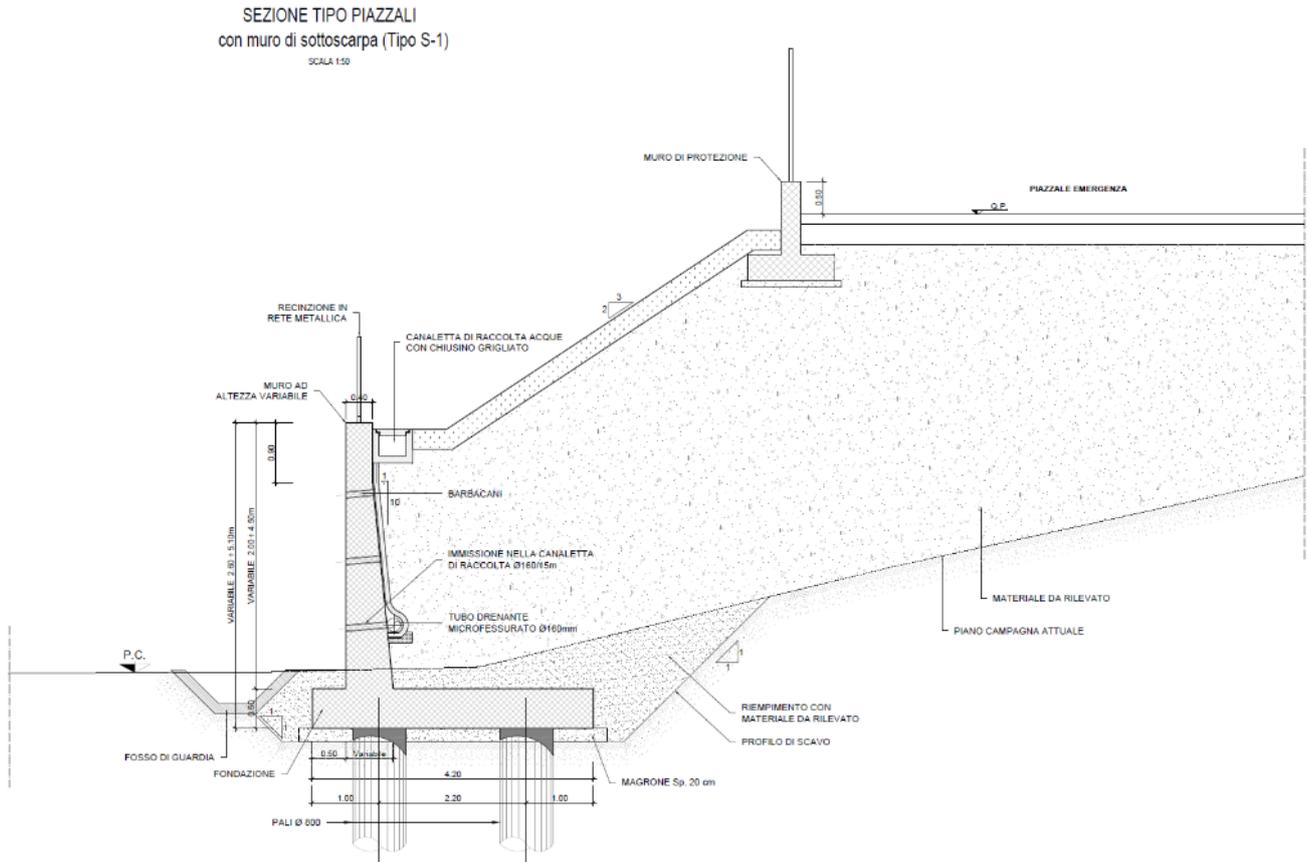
Sezione tipo con muro di sottscarpa (tipo S-1)
